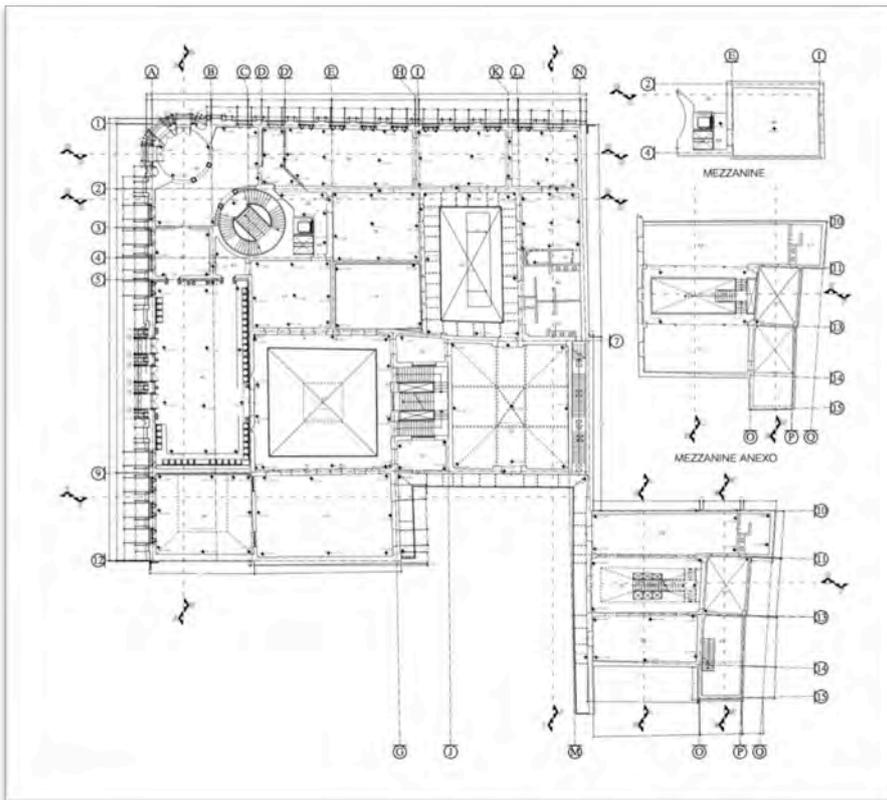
Planta Alta de estado actual. Planos hechos por el Instituto de Ingeniería.
